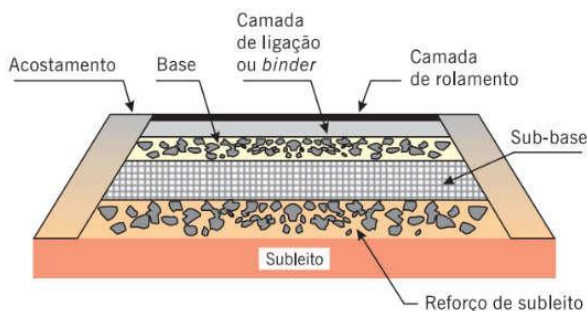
Camadas do pavimento. Fonte: Bernucci *et al.* (2010)<sup>2</sup>.
